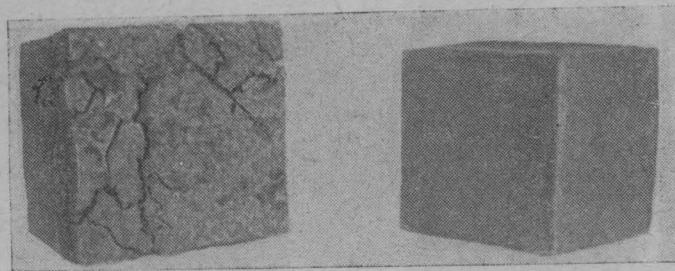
Внешний вид образцов гранита. Слева — образец, прогретый до температуры 800° . Справа — образец, не подвергавшийся нагреву.
